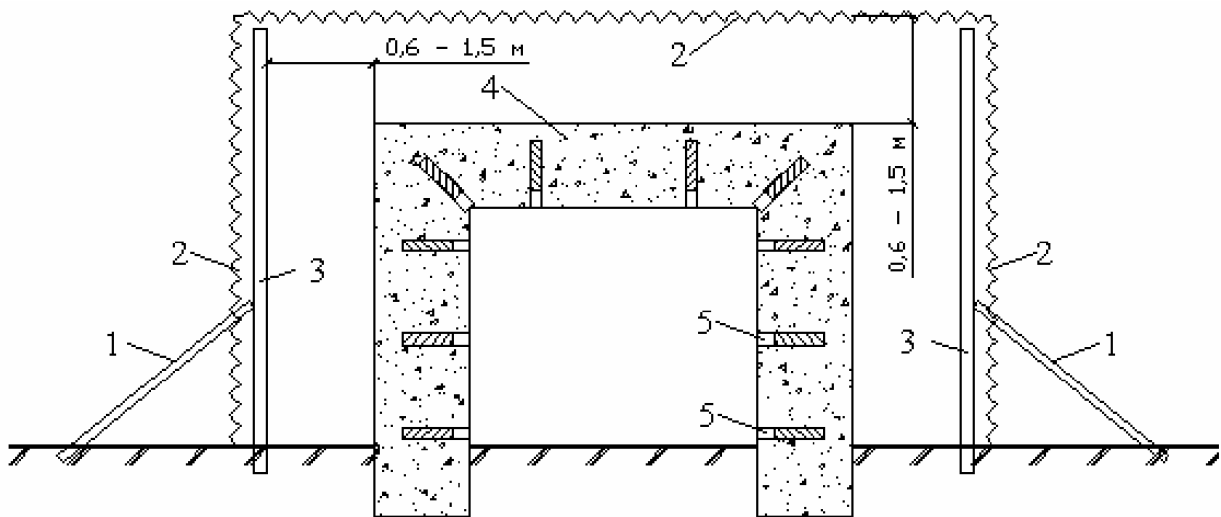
Схема розміщення шпурових зарядів при руйнуванні фундаменту:
